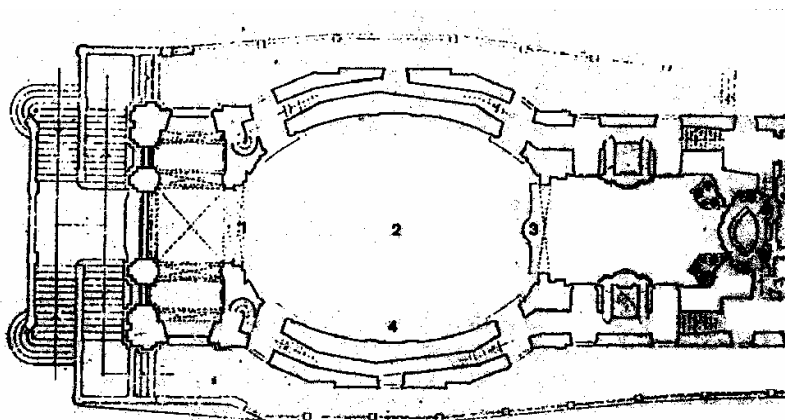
Planta da igreja dos Clérigos (Porto) [3]
